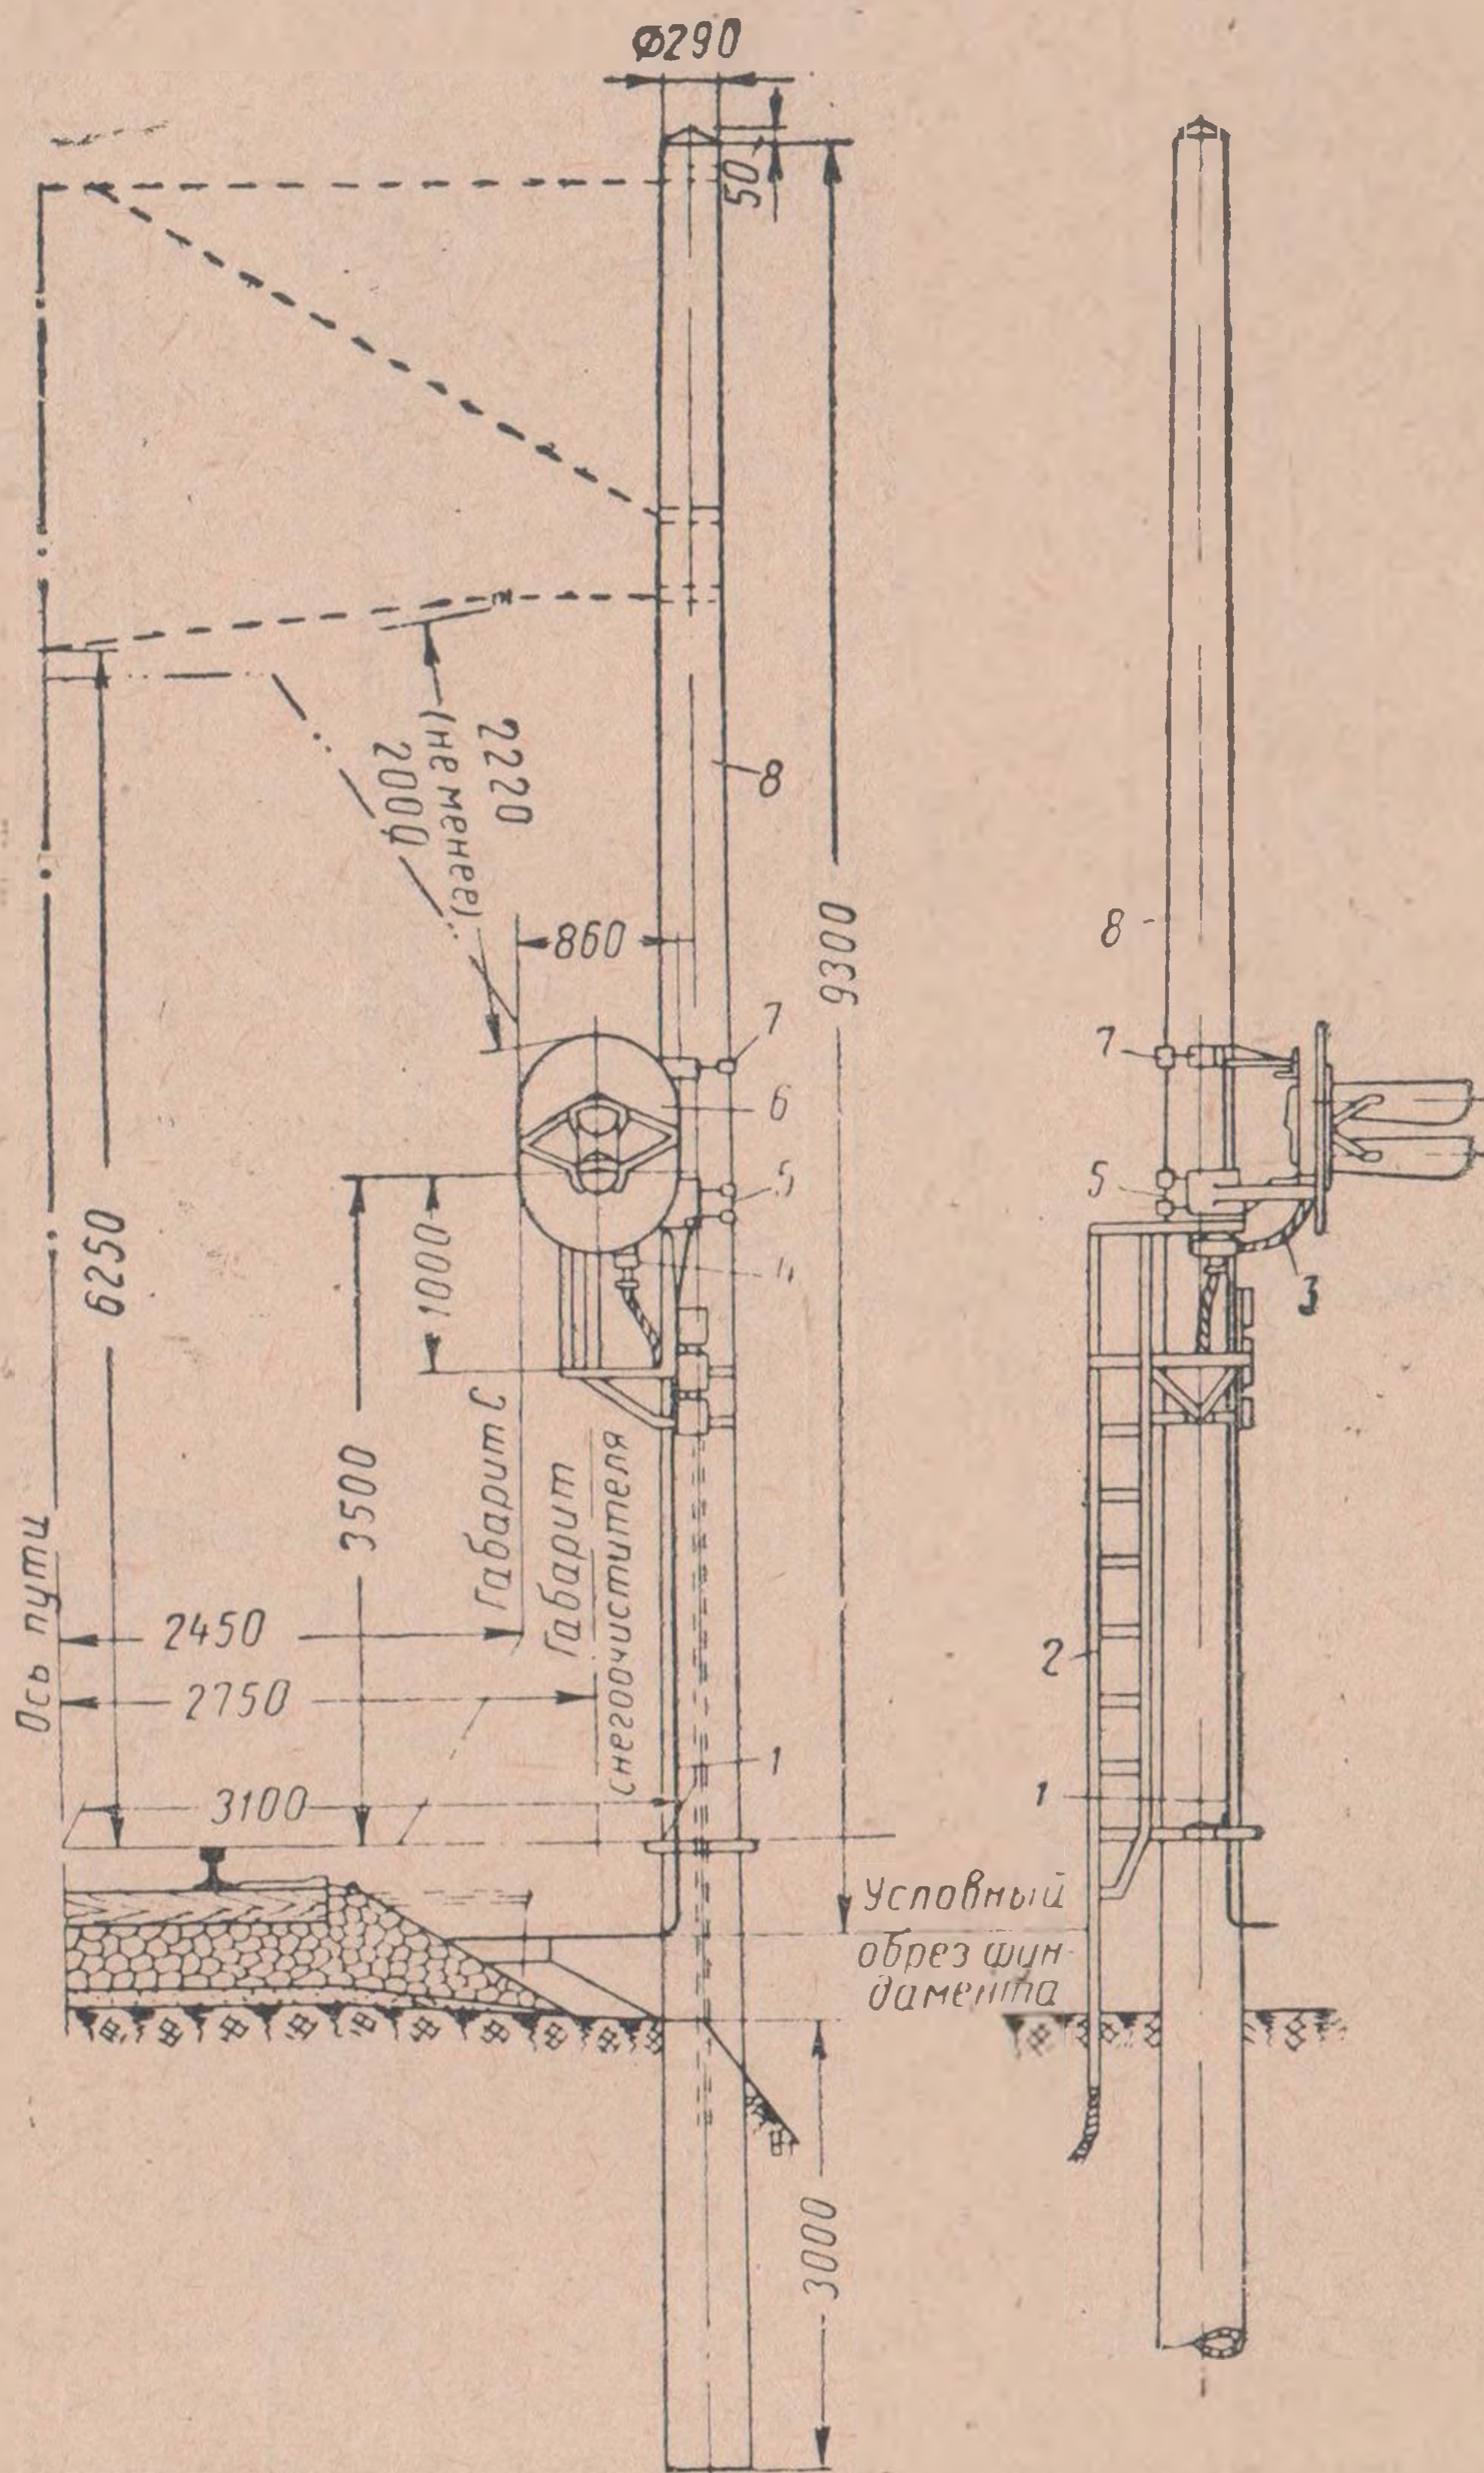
Установка световой головки на железобетонной опоре контактной сети
